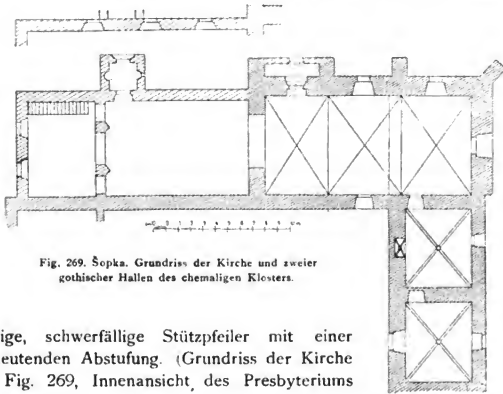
Šopka. Grundriss der Kirche und zweier gothischer Hallen des ehemaligen Klosters.
